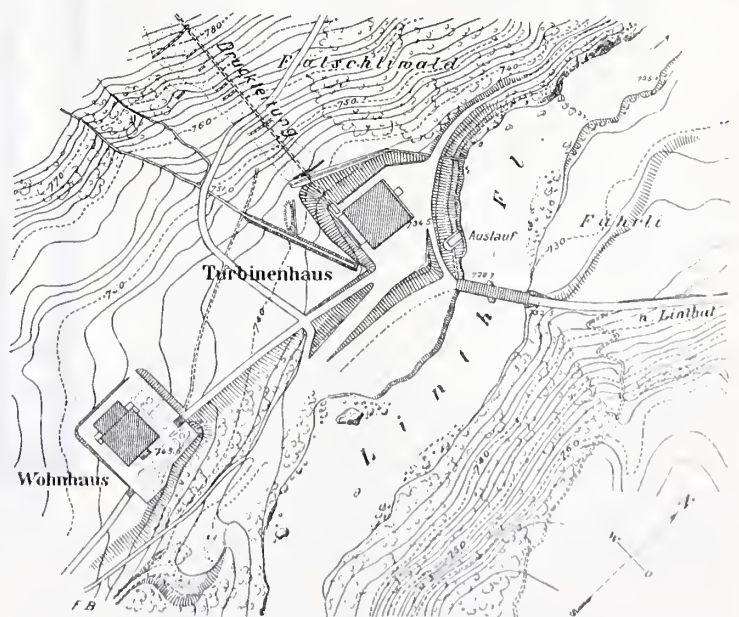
Lageplan der Kraftzentrale. — Masstab 1 : 2000.
